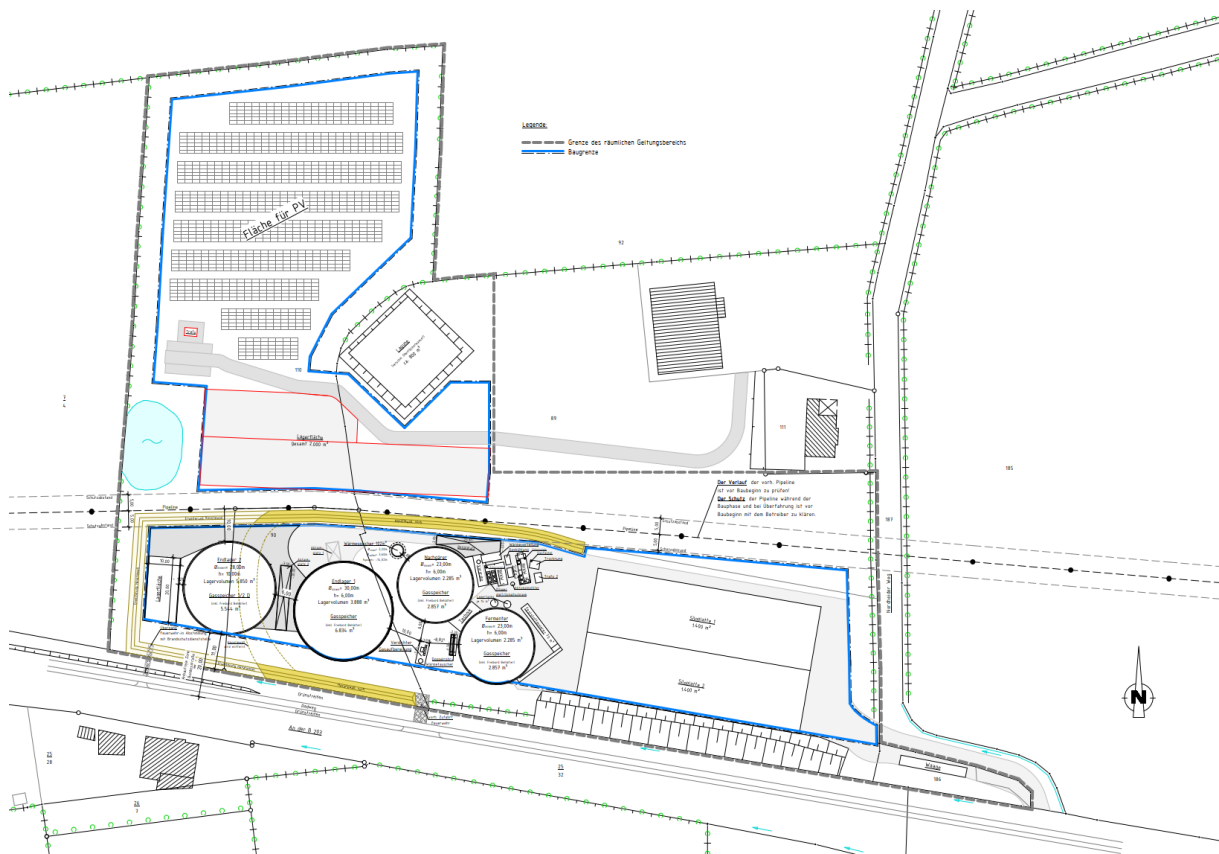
Auszug aus dem Lageplan, rot = geplante Lagerfläche, schwarz = Bestandsanlagen. Quelle: Architekturbüro Falkenhagen + Falkenhagen, Stand: 06.08.2025.
